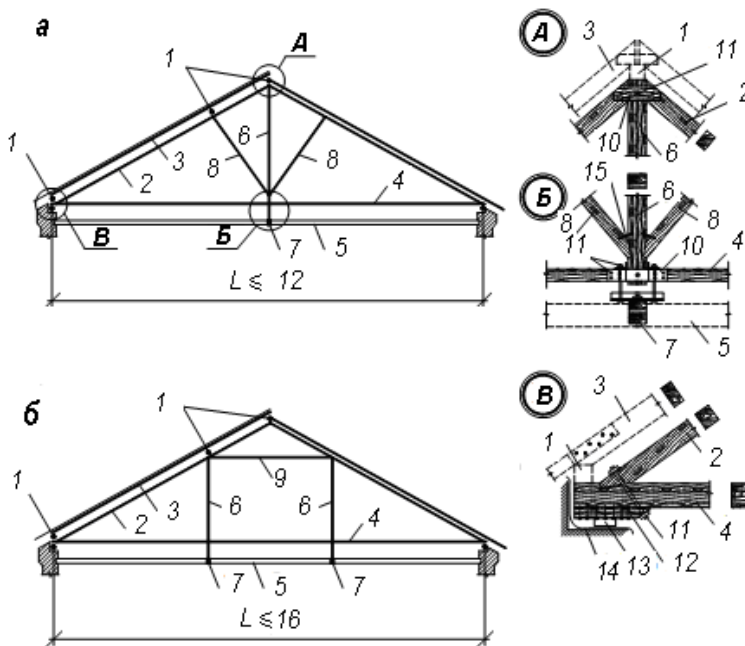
Характерні схеми підвісних крокв: а, б – схеми крокв; 1 – прогін; 2,4 – верхній та нижній пояси ферми; 3 – кроквяна нога; 5 – балка для горищного перекриття; 6 – стійка (підвісна бабка); 7 – прогін горищного перекриття; 8 – підкіс; 9 – ригель; 10 – накладка (дерев'яна або сталева) з двох сторін; 11 – болт; 12 – коротун; 13 – антисептована прокладка; 14 – толь; 15 – скоба
